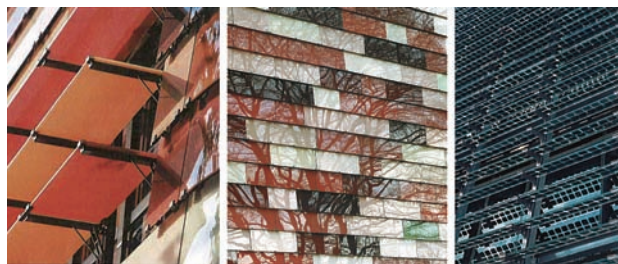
縦ルーバー 写真-6 パンチングやポリカーボネート³⁾
